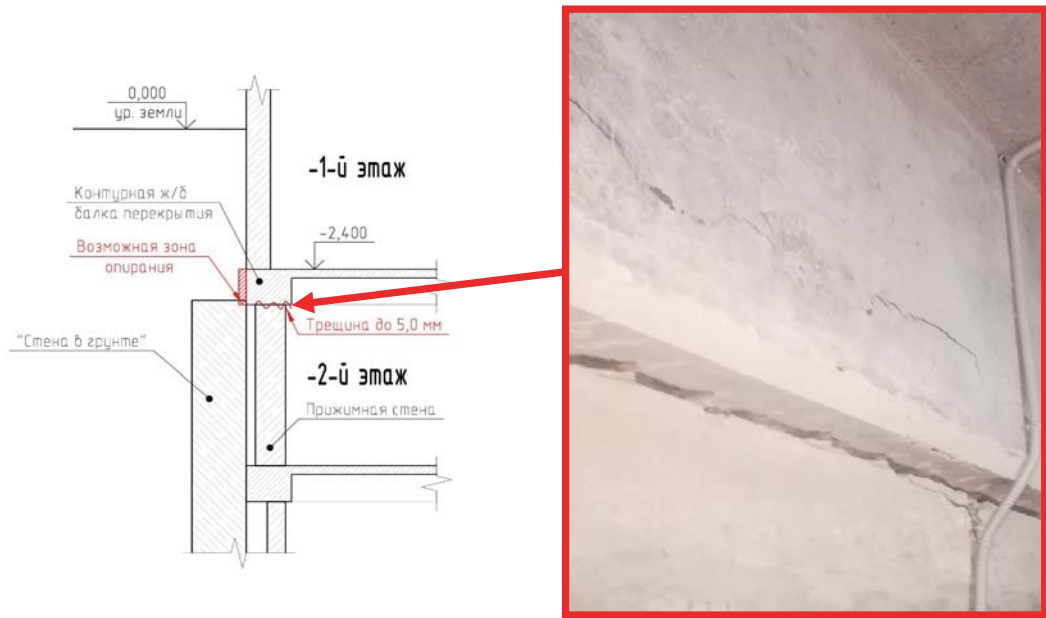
Трещина, зафиксированная в зоне сопряжения прижимной стены по оси «А'» с контурной балкой перекрытия 2-го этажа
